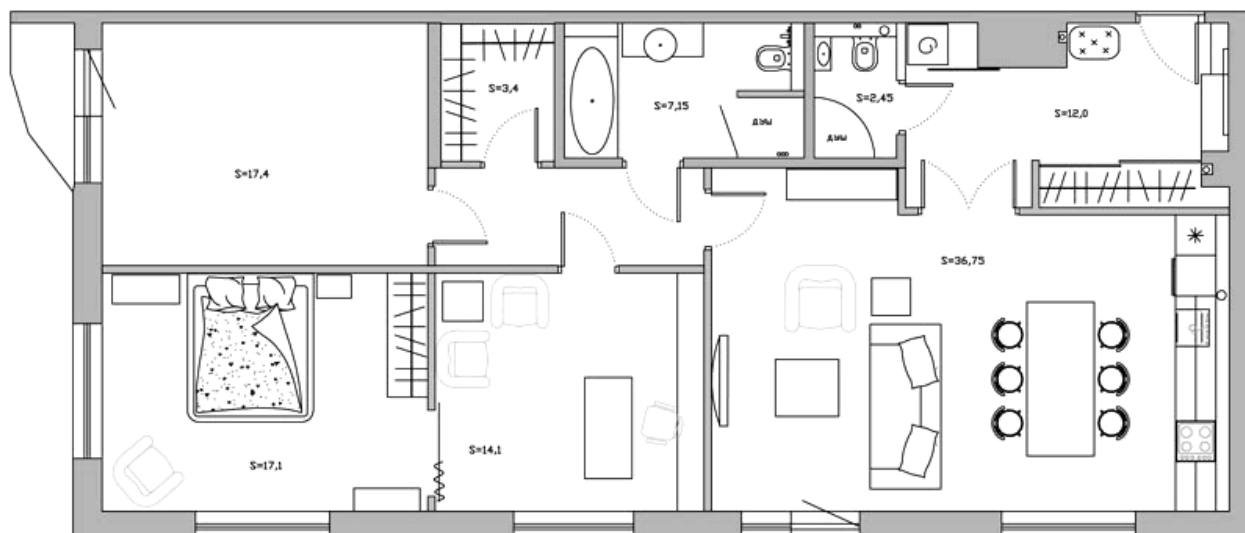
Планировочное решение квартиры для разработки схемы электрики
